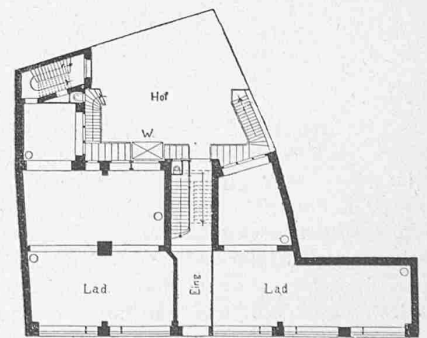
Grundriss vom Erdgeschoss 1:500.
